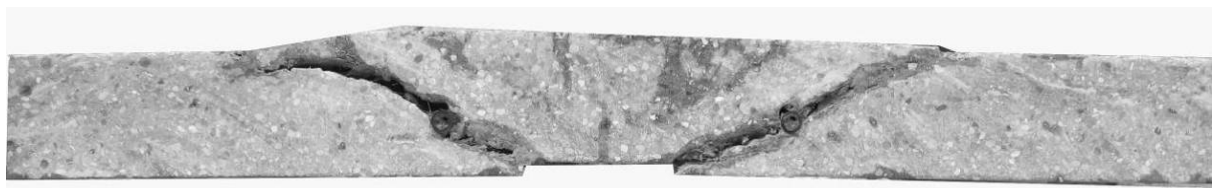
Fissuration à plusieurs niveaux de charge et fissures internes de la dalle B5-03.
